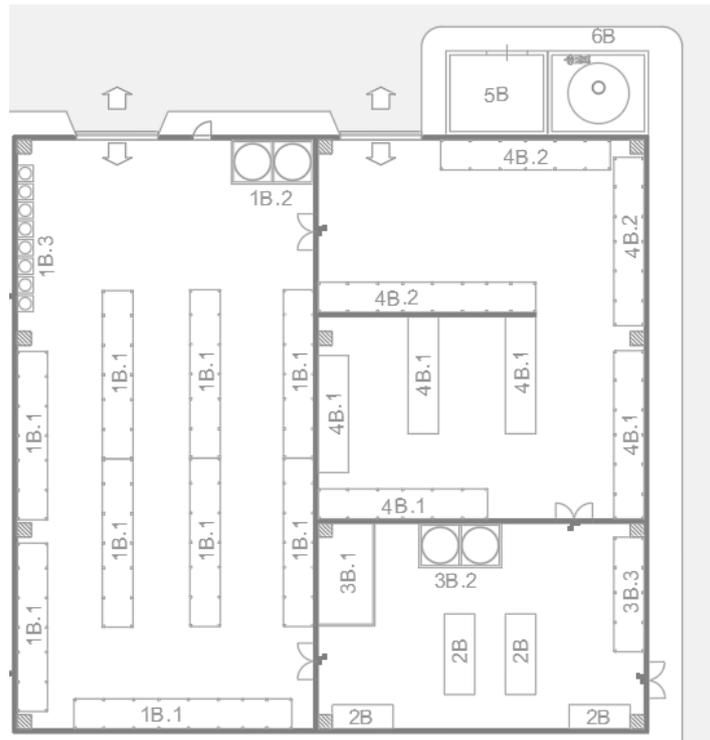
Vista in pianta della sezione di trattamento RAEE
